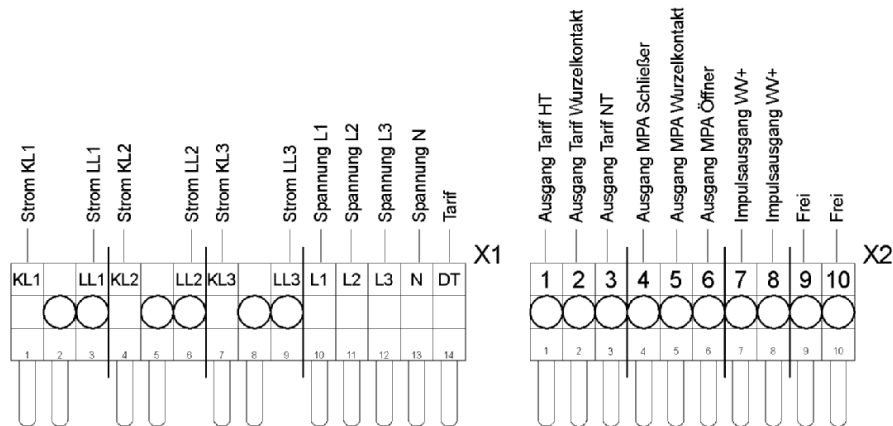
Klemmenbelegung Zählerschrank für Wandlermessung
